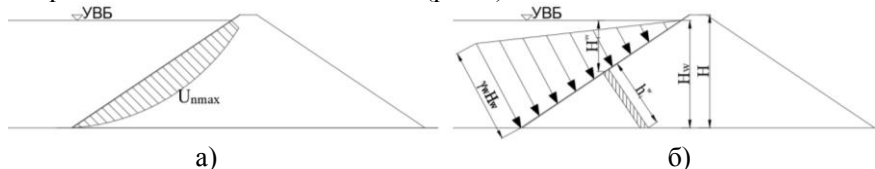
Расчетные схемы для определения прогибов железобетонного экрана
